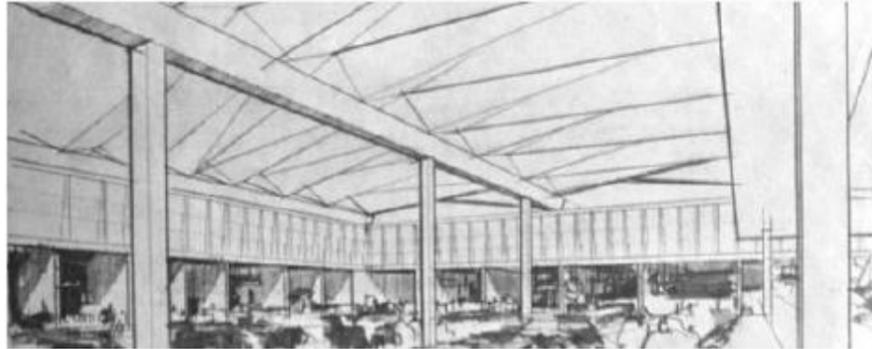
Interior de la Plaza de Mercado de Paloquemao. Fuente: Revista Escala # 20 - Centro de Abastos (1967)
